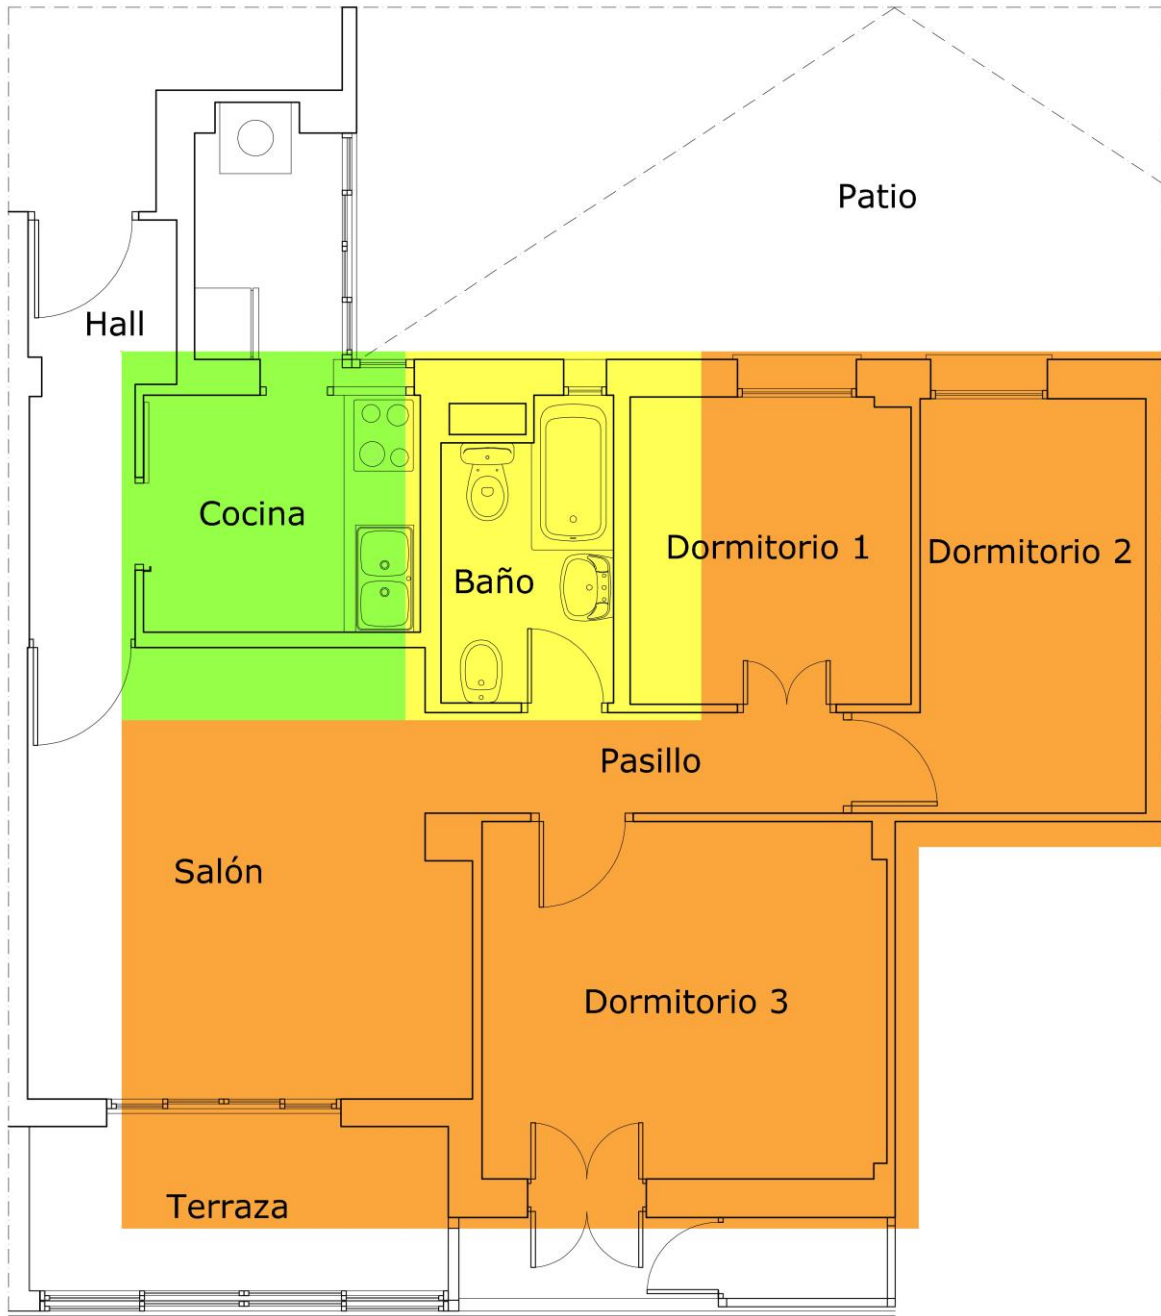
Plano de planta de las zonas de actuación de las diferentes opciones.
